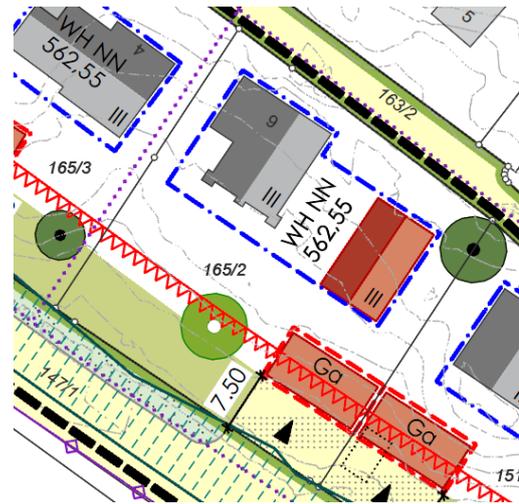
Auszug aus dem Bebauungsplan, Ohne Maßstab
